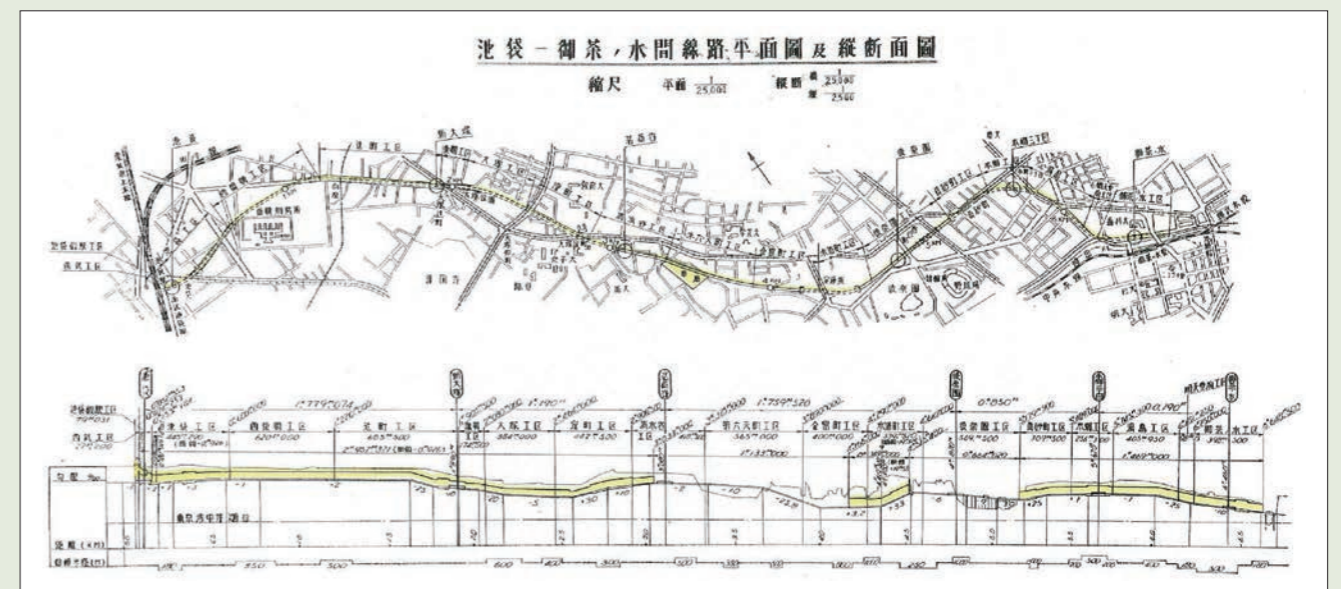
池袋～御茶ノ水間の線路平面図と縦断面図
